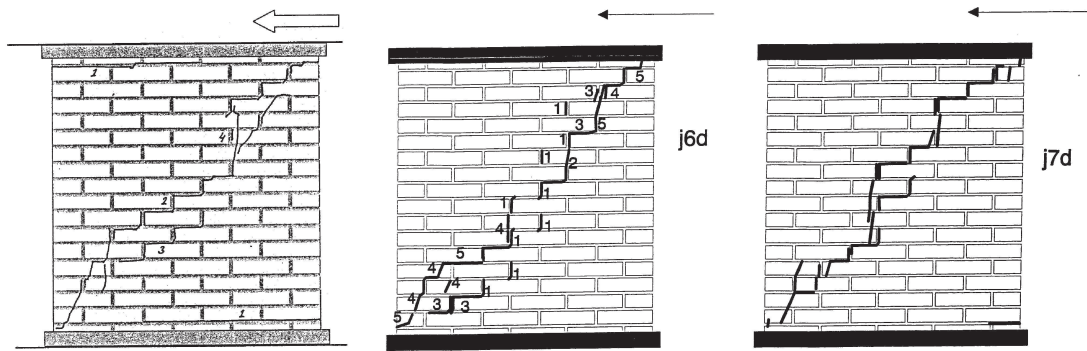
Fissuration obtenue lors des essais effectués par Raijmakers and Vermeltfoort (1992) sur les murs J4D, J6D et J7D.
